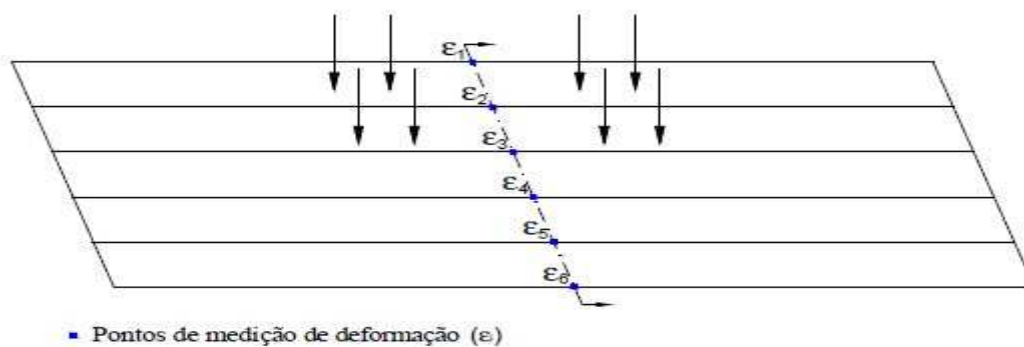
Planta do tabuleiro analisado e esquema de veículo genérico (Moses, 1979 *apud* Pimentel, 2008)
